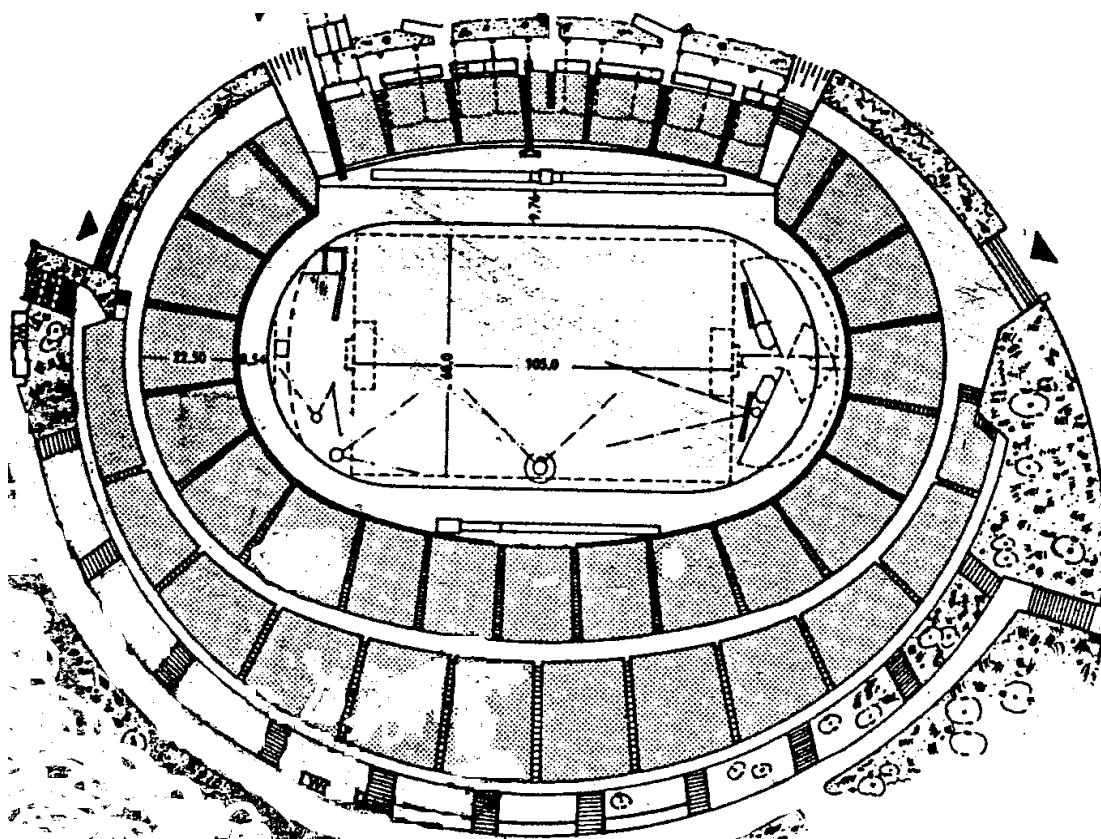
План стадіону в Ганновері (Нижня Саксонія). Архіт. Гесман Хілленбрант. (Э. Нойферт. Строительное проектирование. -М: Стройиздат, 1991. - 392 с.)
